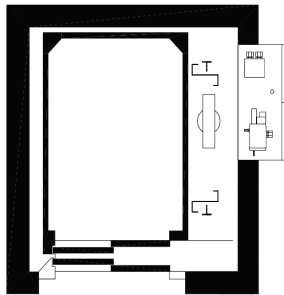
Seilhydraulischer Aufzug – Grundriss
